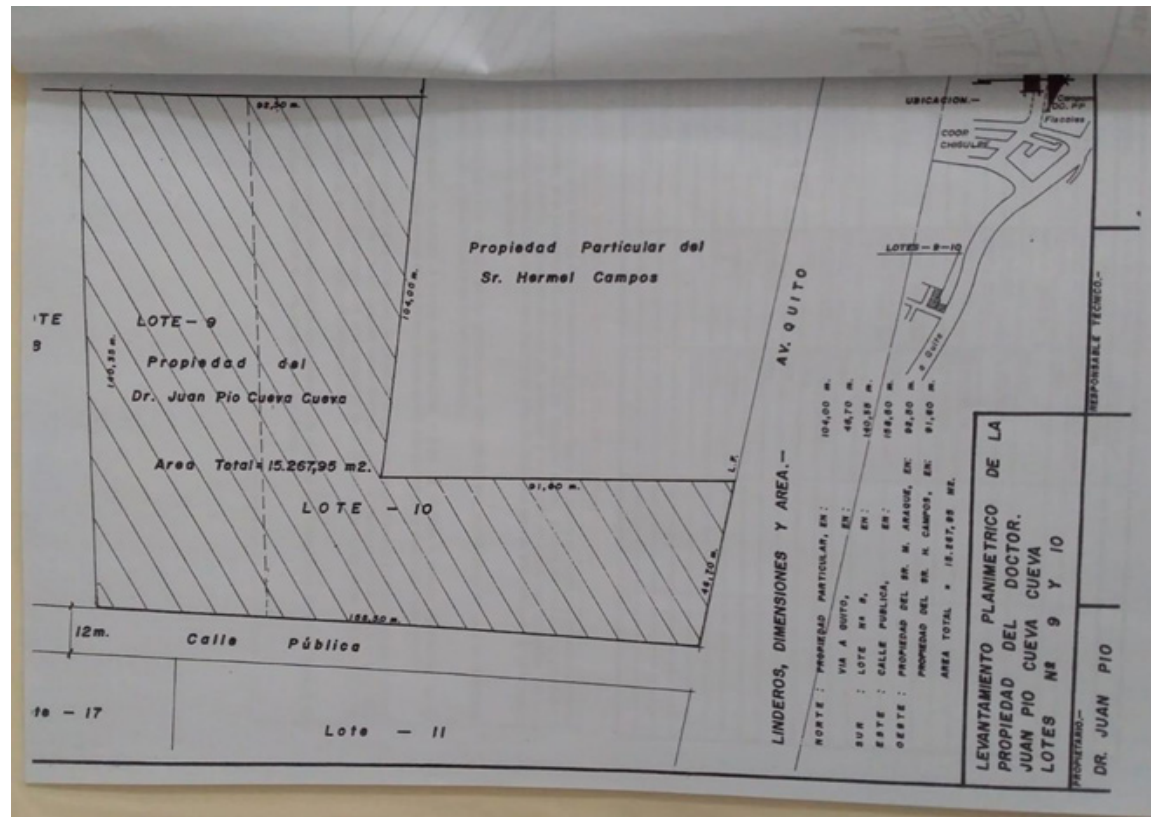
Fotografía del plano del terreno donde se ubicará el proyecto.
